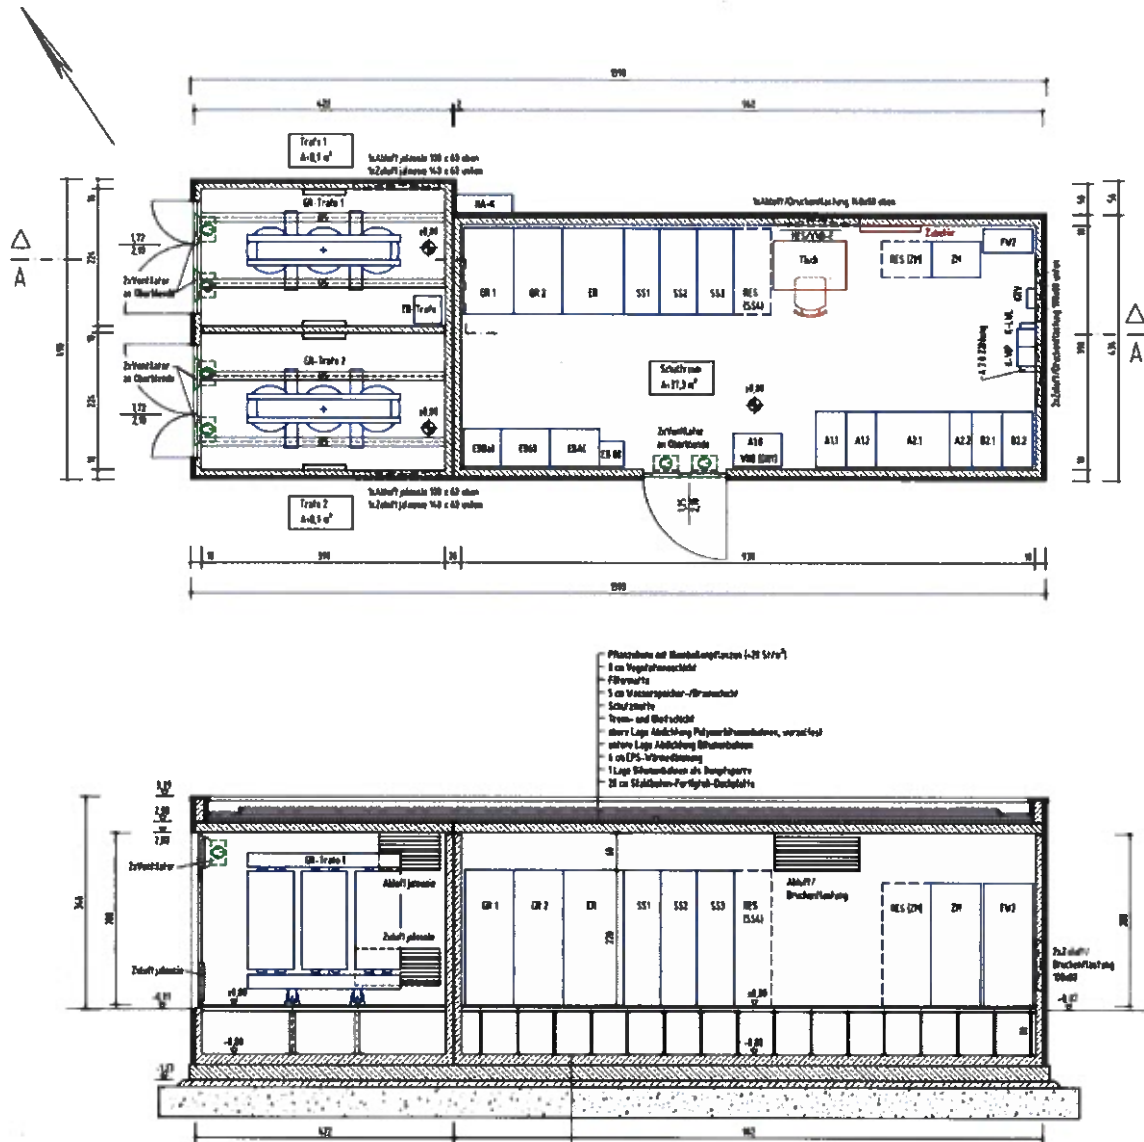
Grundriss und Querschnitt des TGW [11].
